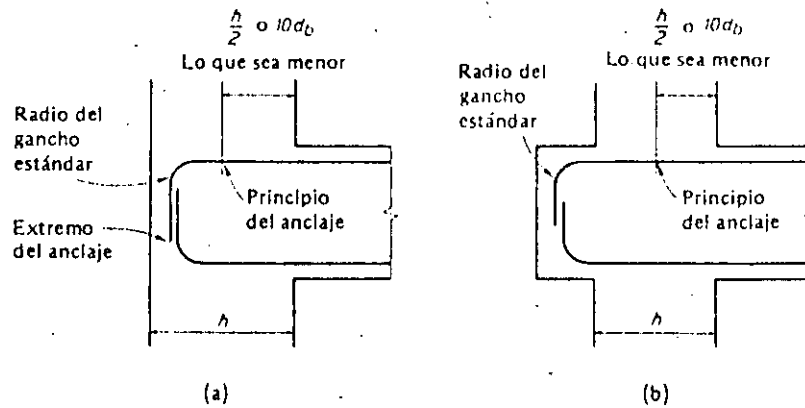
Anclaje de las varillas de la viga en una columna exterior, cuando es factible que se forme la articulación plástica en la viga en el paño de la columna. a) Anclaje en las columnas, b) anclaje en el talón de la viga.
